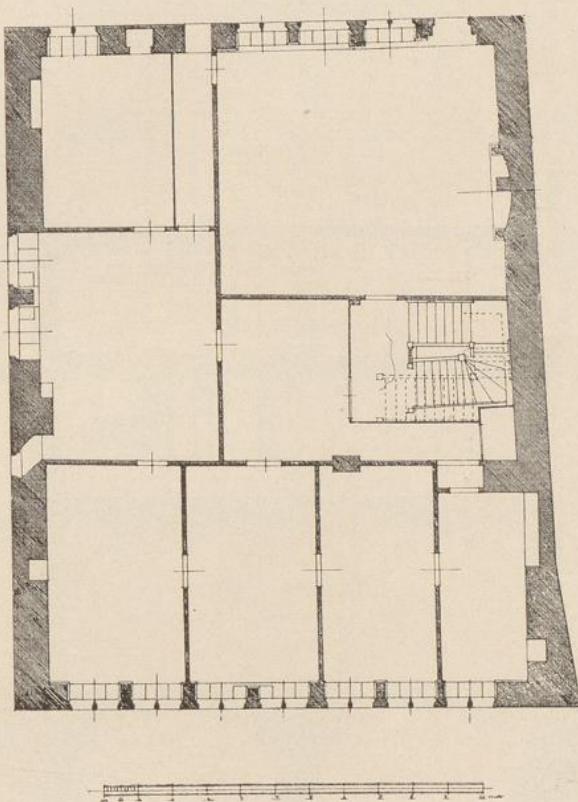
Steinernes Haus; erstes Obergeschoß.
